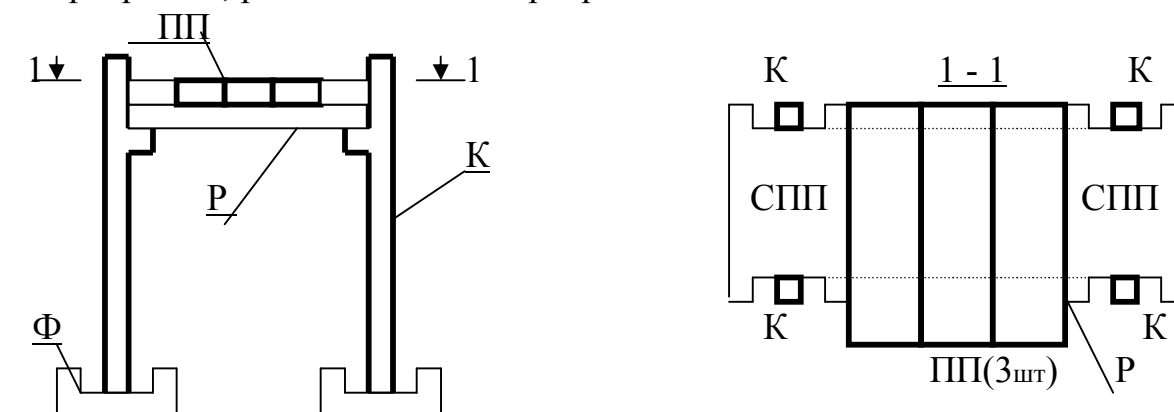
Схема ячейки. Ф – фундаменты; К- колонны; Р – ригели; СПП – связевые плиты перекрытий; ПП – рядовые плиты перекрытий.
